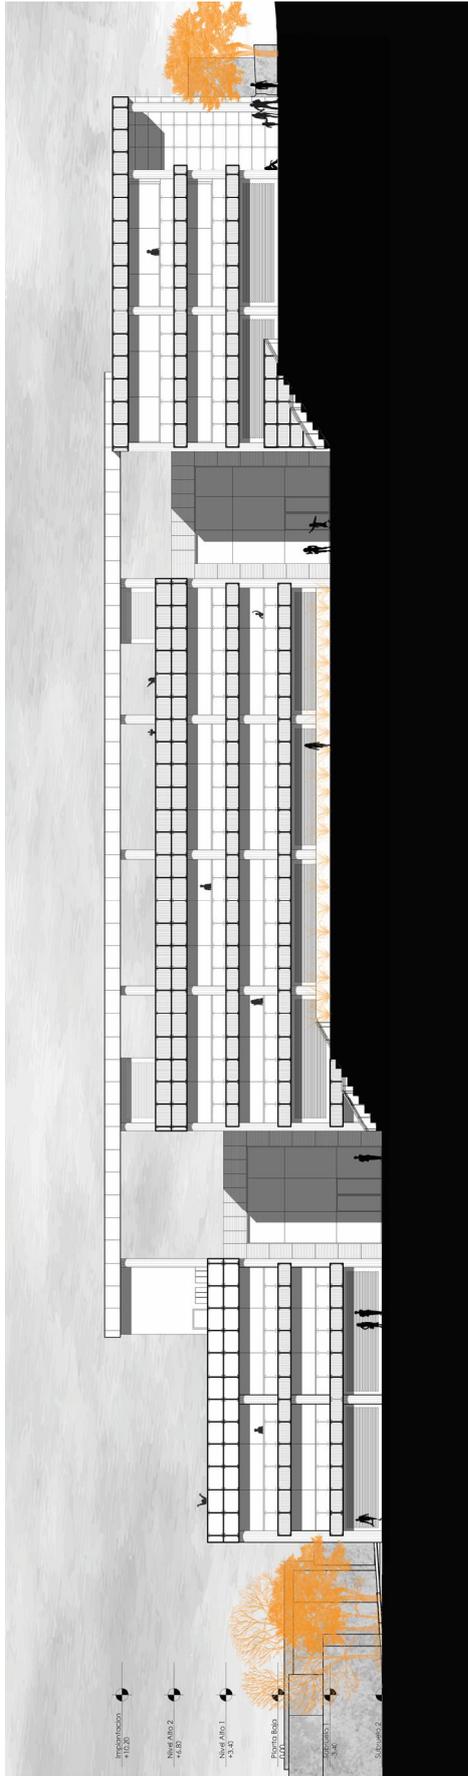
Fachadas Norte y Oeste (elaboración propia)
